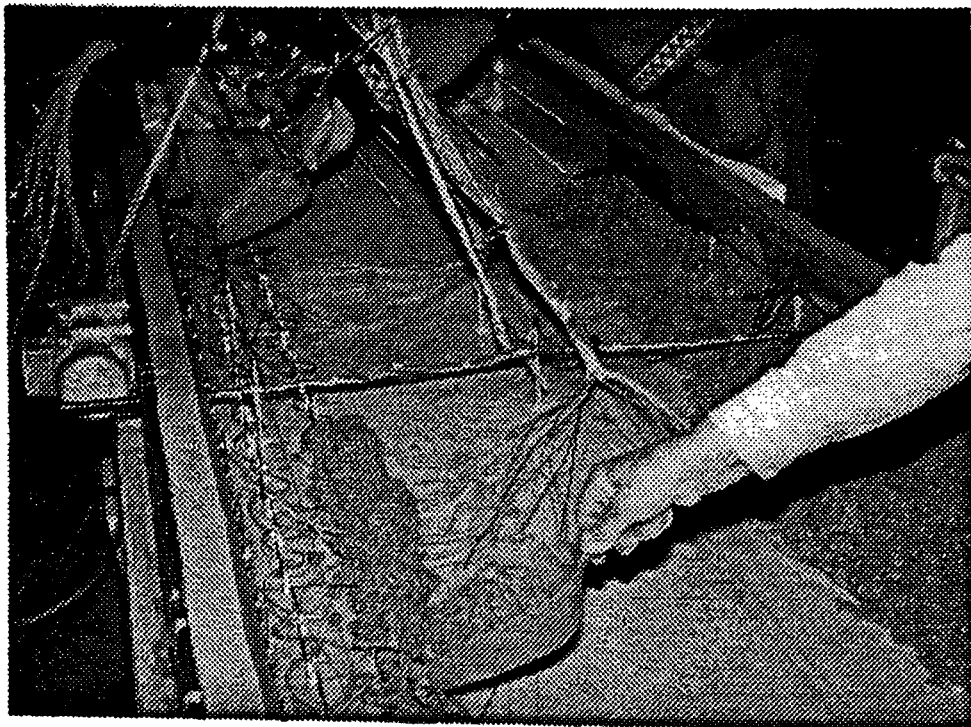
Betoneinbringung bei den EW-Versuchen
